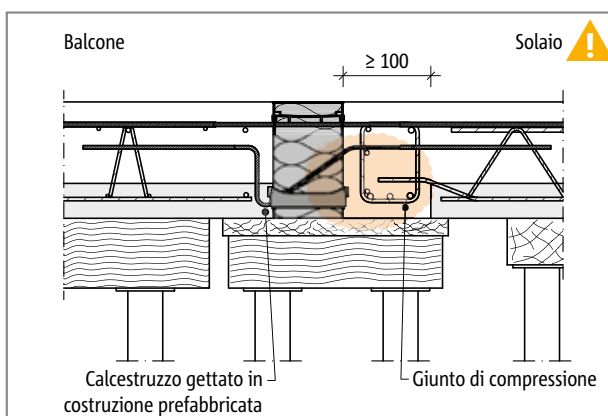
Schöck Isokorb® tipo KFXT: giunto di compressione lato solaio collegato a piastre prefabbricate; appoggio indiretto
